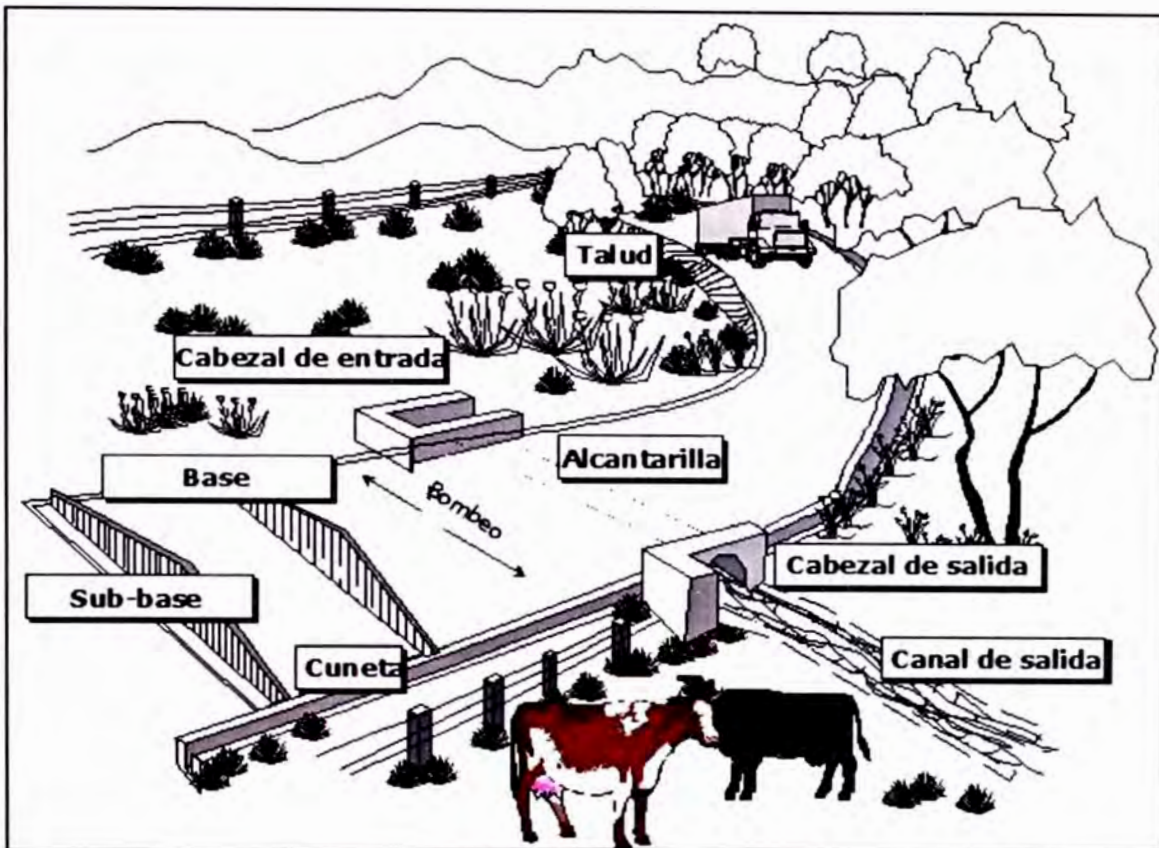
Sistema de drenaje y partes de la infraestructura vial
